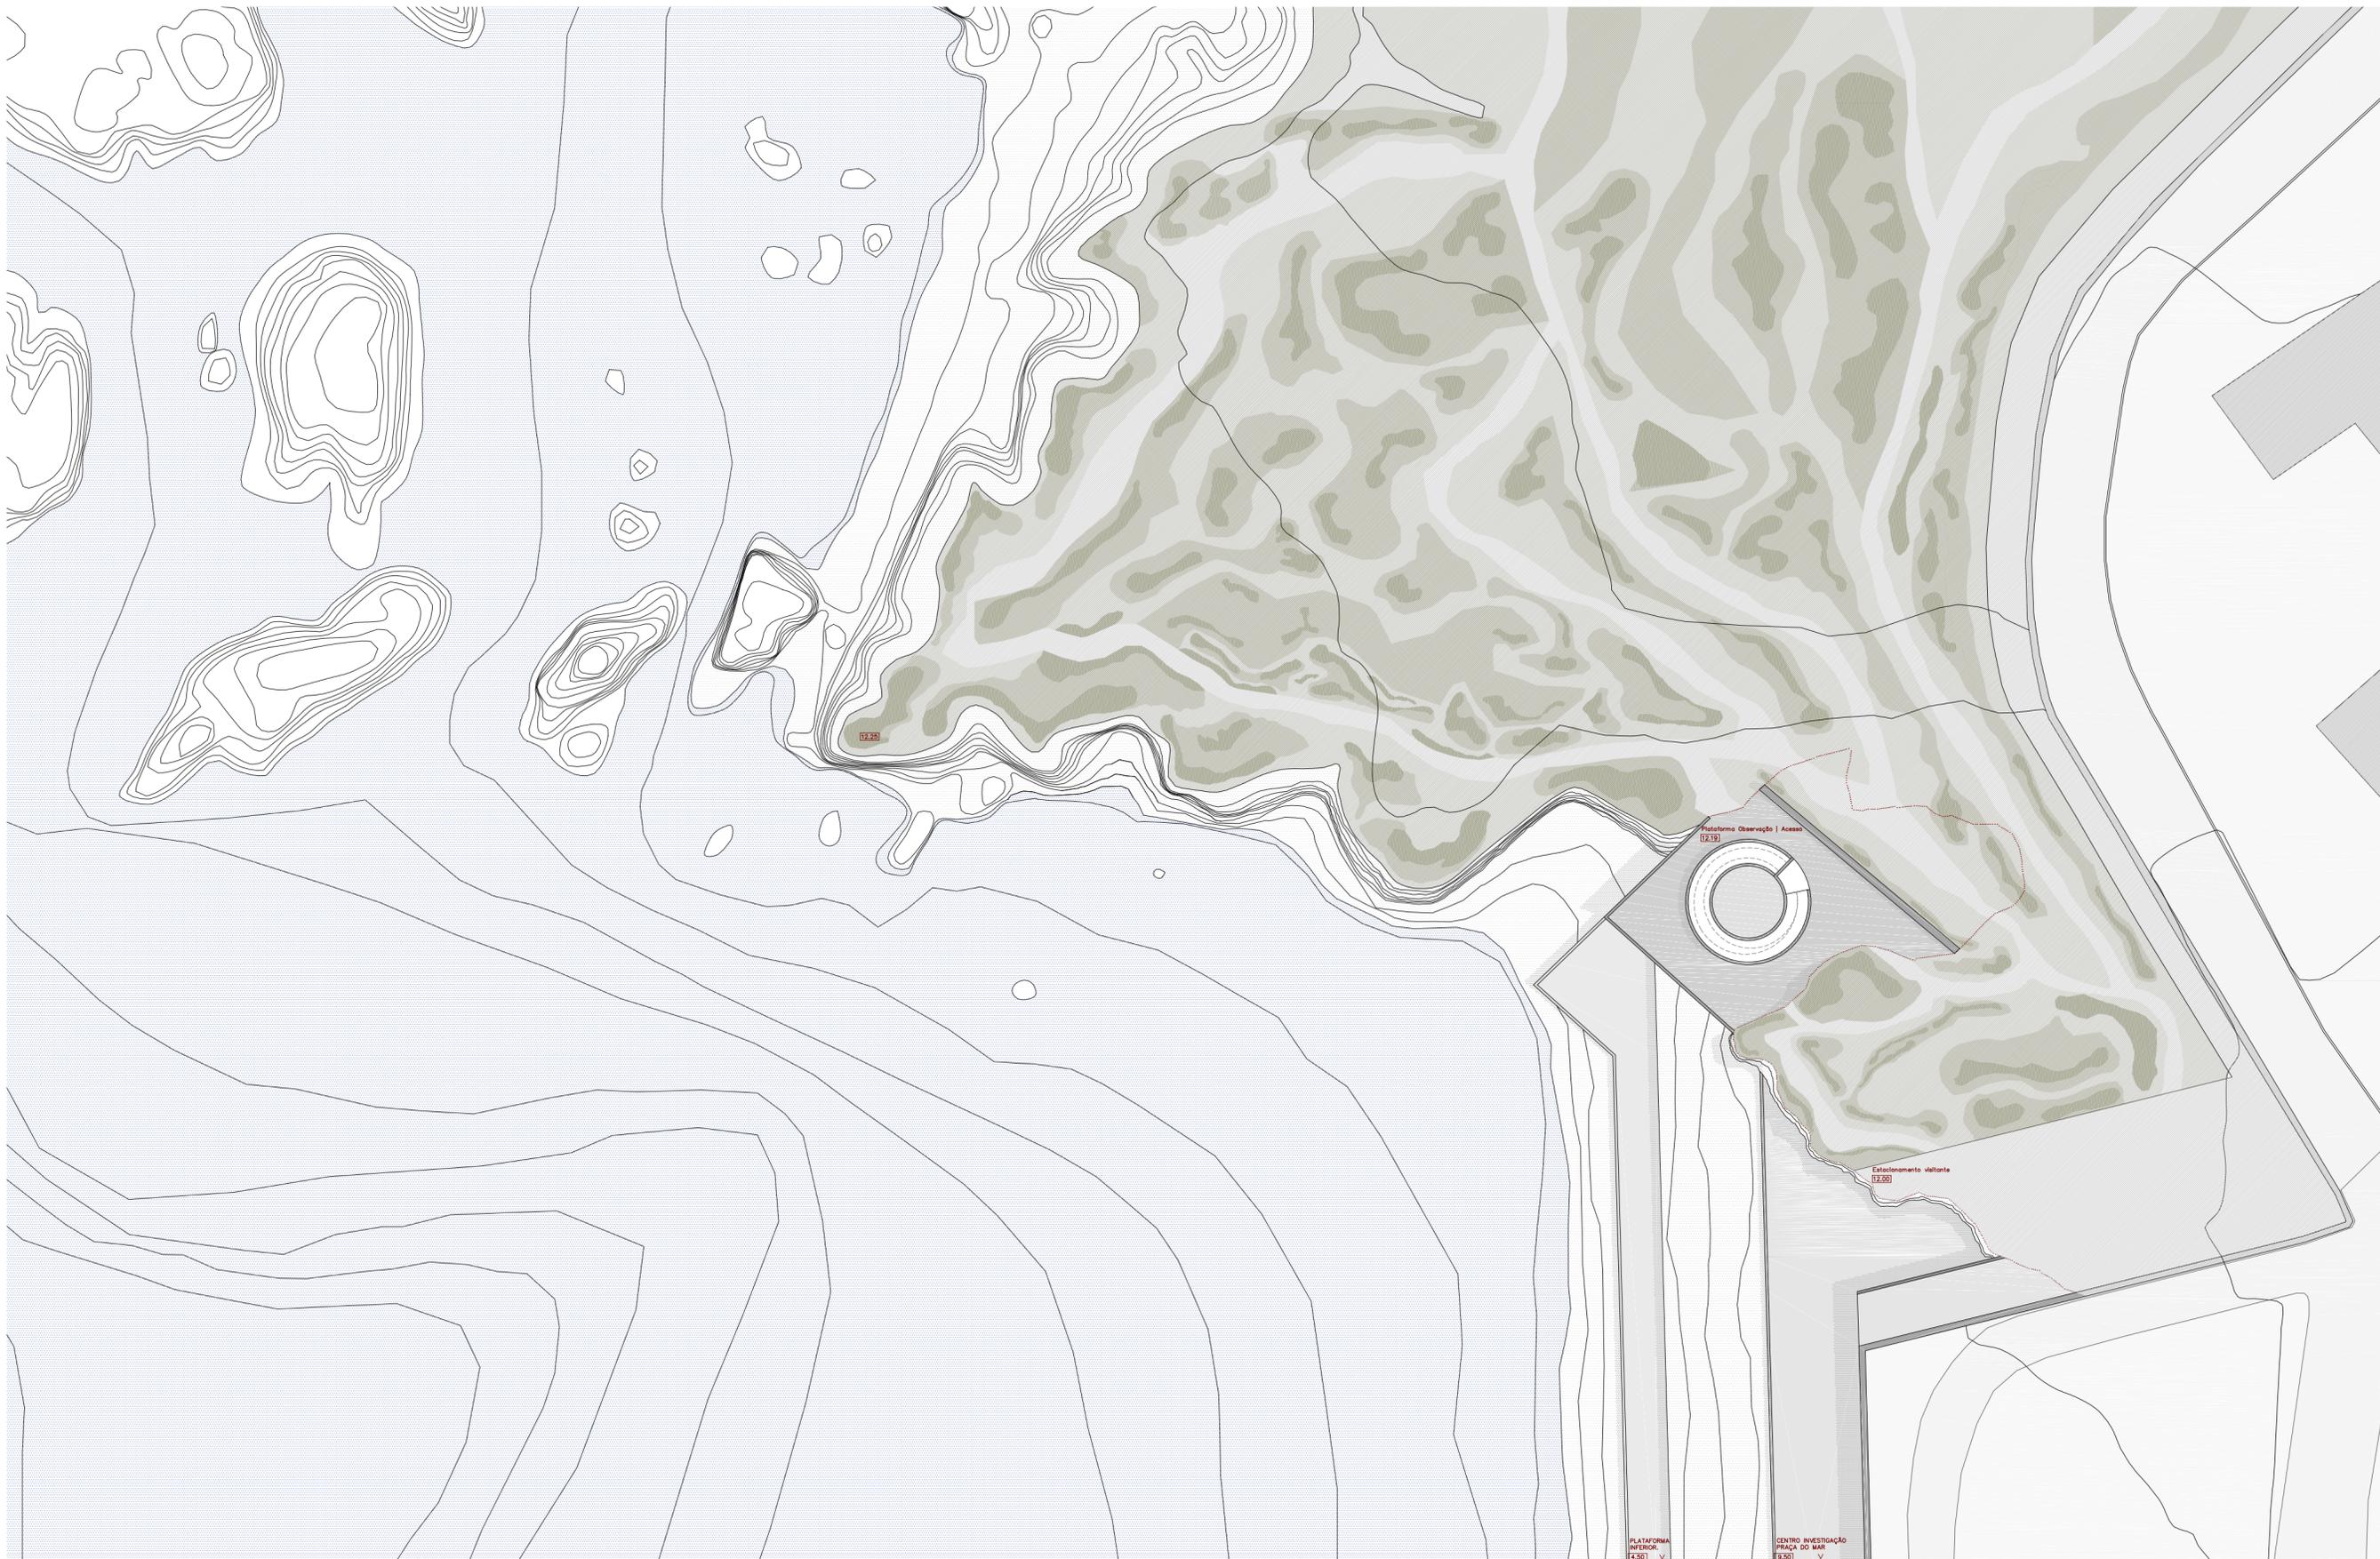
Espaço do Cabo, Planta de Cobertura esc. 1_500
